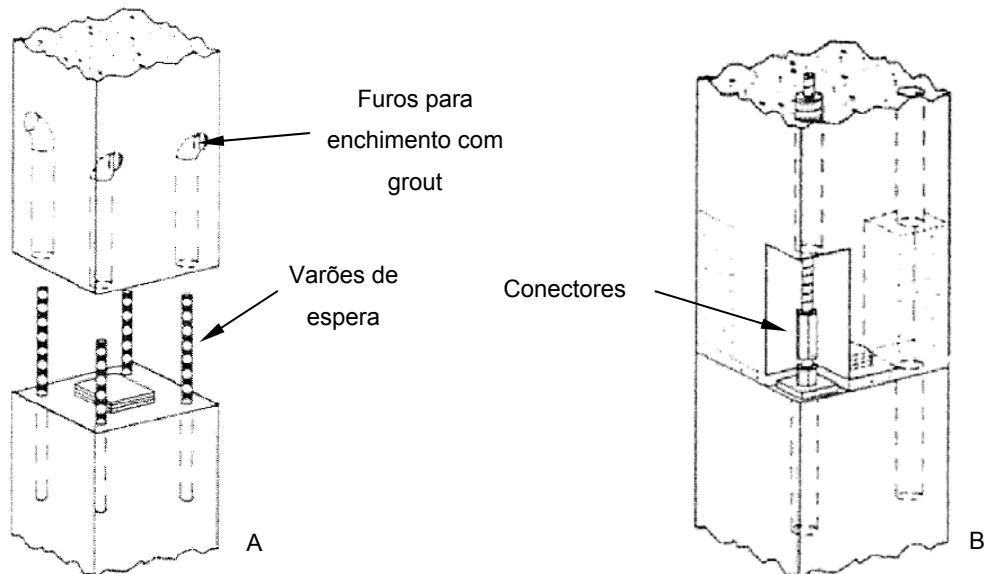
Ligação pilar – pilar, A – através de bainhas, B – através de conectores [26]
